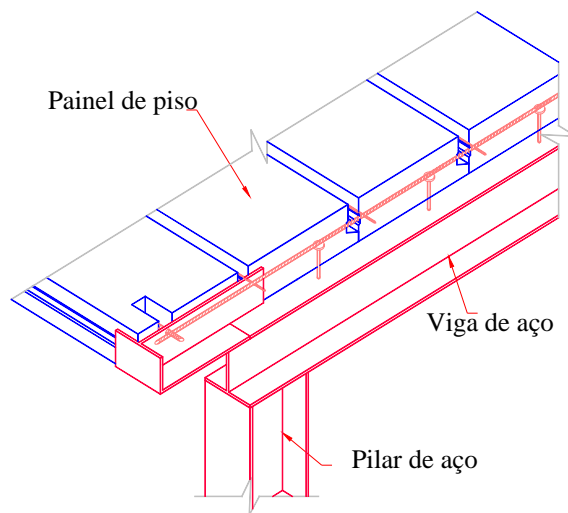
Ligação de painéis de piso/cobertura a viga de aço (fonte: CURRAN, 2003)
